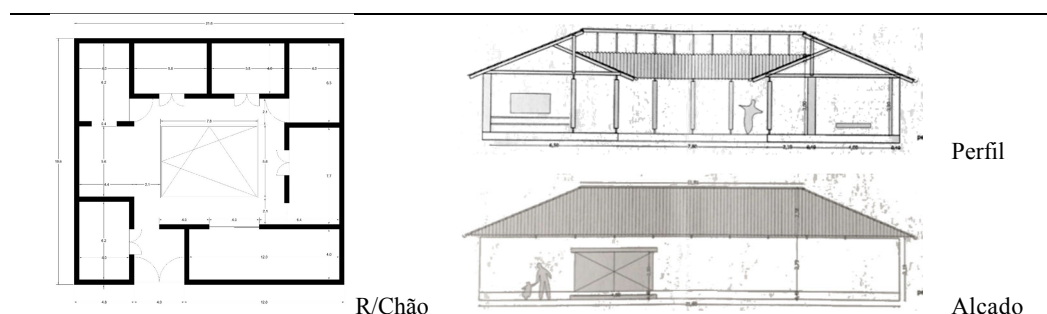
Caso de estudo - geometria (planta, corte e alçado principal)
